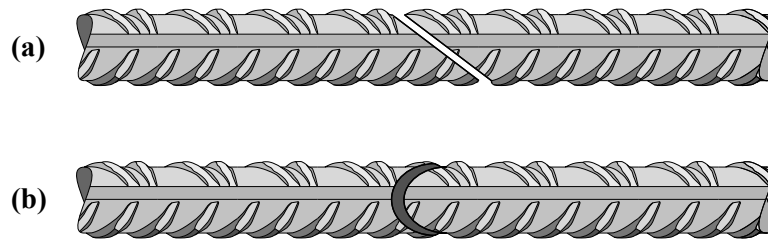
(a) Ansicht und (b) Draufsicht eines Bewehrungsstabes mit zur Längsachse schräg stehenden Bruchflächen.
